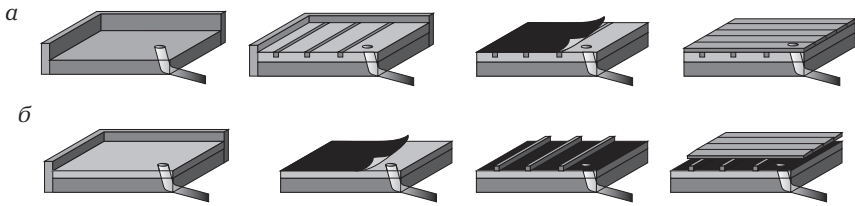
Укладка полов на цементно-песчаную стяжку в саунах: а — с утоплением лаг в раствор; б — поверх стяжки
